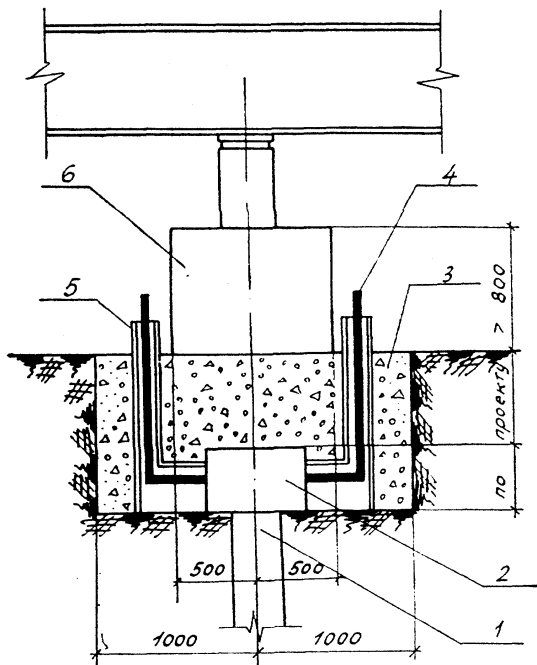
СХЕМА ОПЫТНОГО ФУНДАМЕНТА
